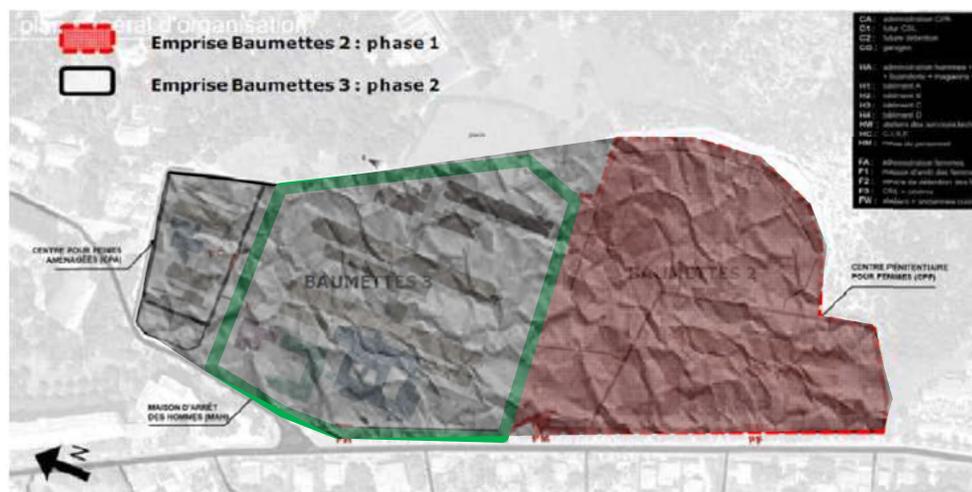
Schéma d'organisation du site et zone concernée par cette mission (en vert : Baumettes 3 Historiques ; en rouge : Baumettes 2).
